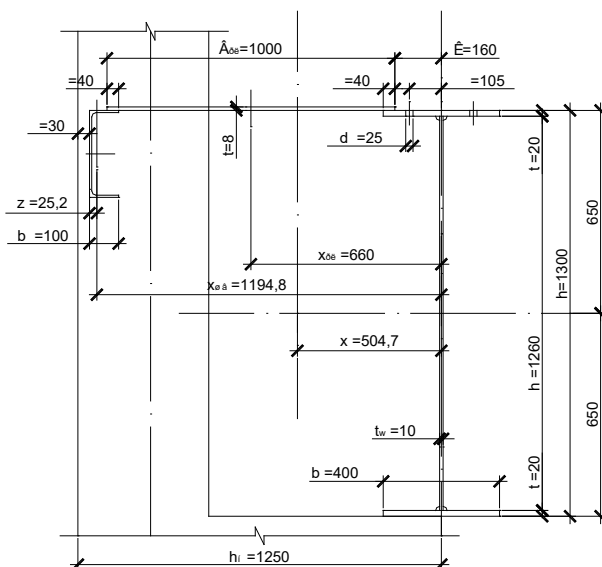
Компоування поперечного перерізу підкранової конструкції
